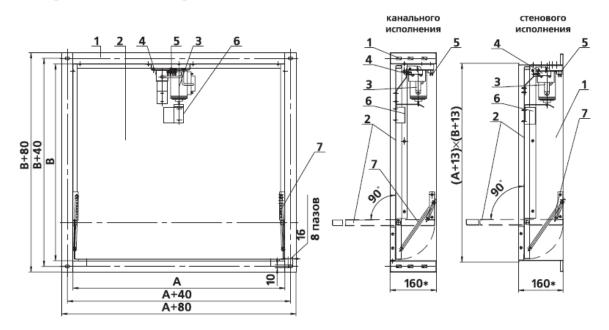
Клапан дымоудаления КПД-4-01 и КПД-4-02 производства ООО «Веза» с электромагнитным приводом, установленным внутри: 1 — корпус; 2 — лопатка; 3 — электромагнит; 4 — конечный выключатель; 5 — клеммная колодка; 6 — рукоятка; 7 — возвратная пружина (* - при комплектации клапана декоративной решеткой глубина корпуса будет составлять 200 мм)
